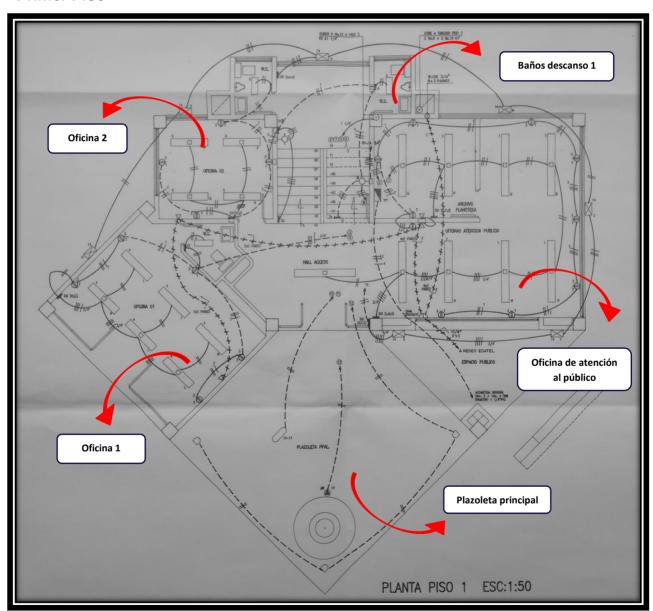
Cornare. (2008). Plano de Distribución del Sistema Eléctrico Planta Primer Piso.
